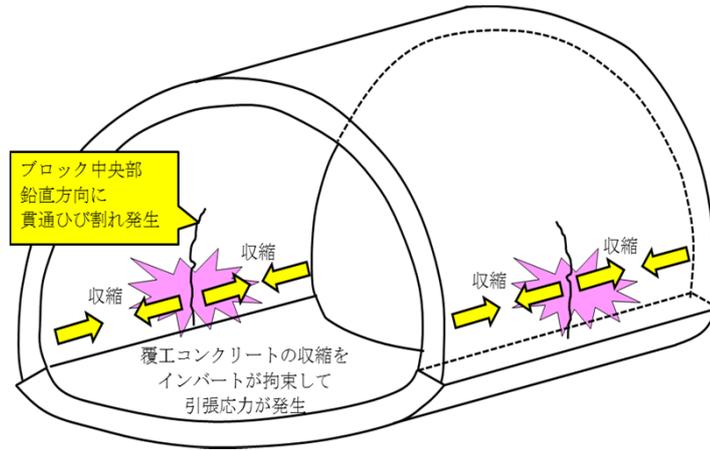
インバートの拘束による覆工コンクリートの温度ひび割れ
